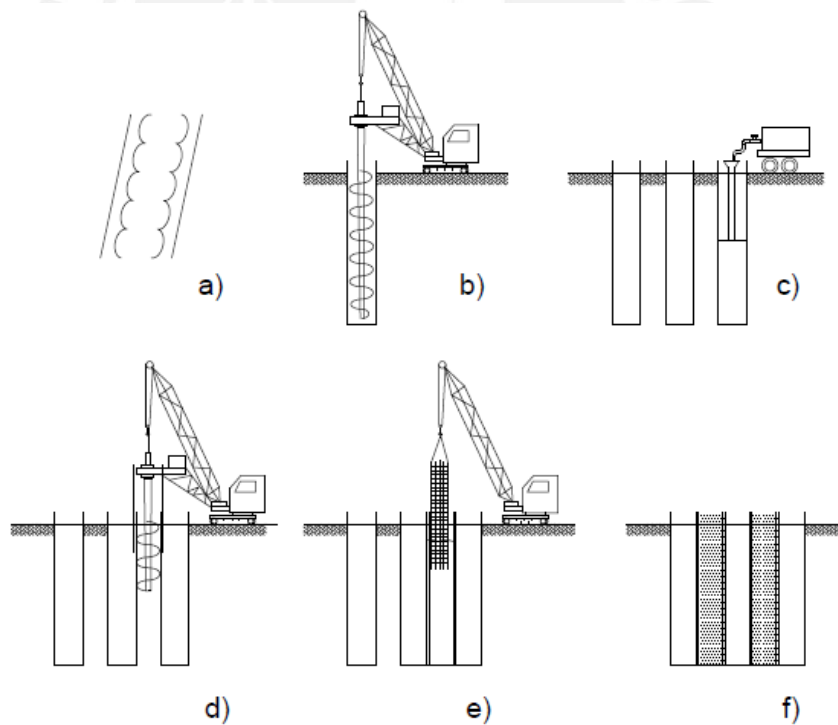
Proceso constructivo de pantalla de pilotes secantes: a) Colocación de plataforma guía, b) Perforación del terreno, c) Vaciado de concreto, d) Perforación de pilotes primarios, e) Colocación de armadura, f) Pilote terminado (Fuente propia, 2015)
